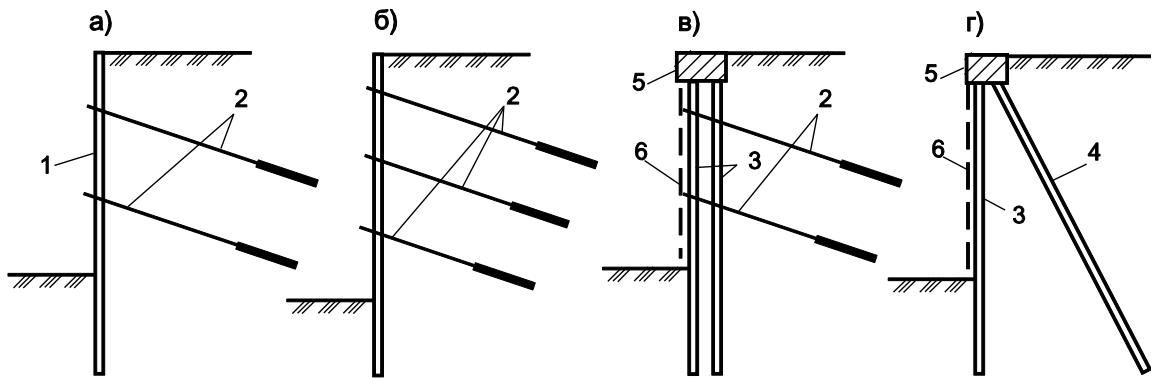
Заанкеренные подпорные и шпунтовые стены
